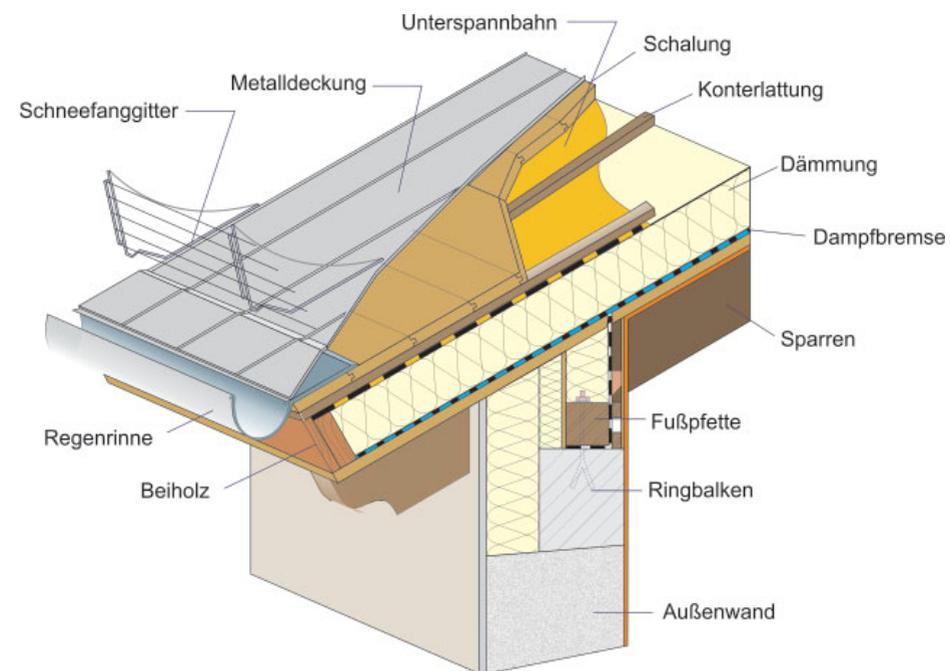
Schema eines Schrägdaches (Variante Aufsparrendämmung) mit Metalldeckung und Unterdach
